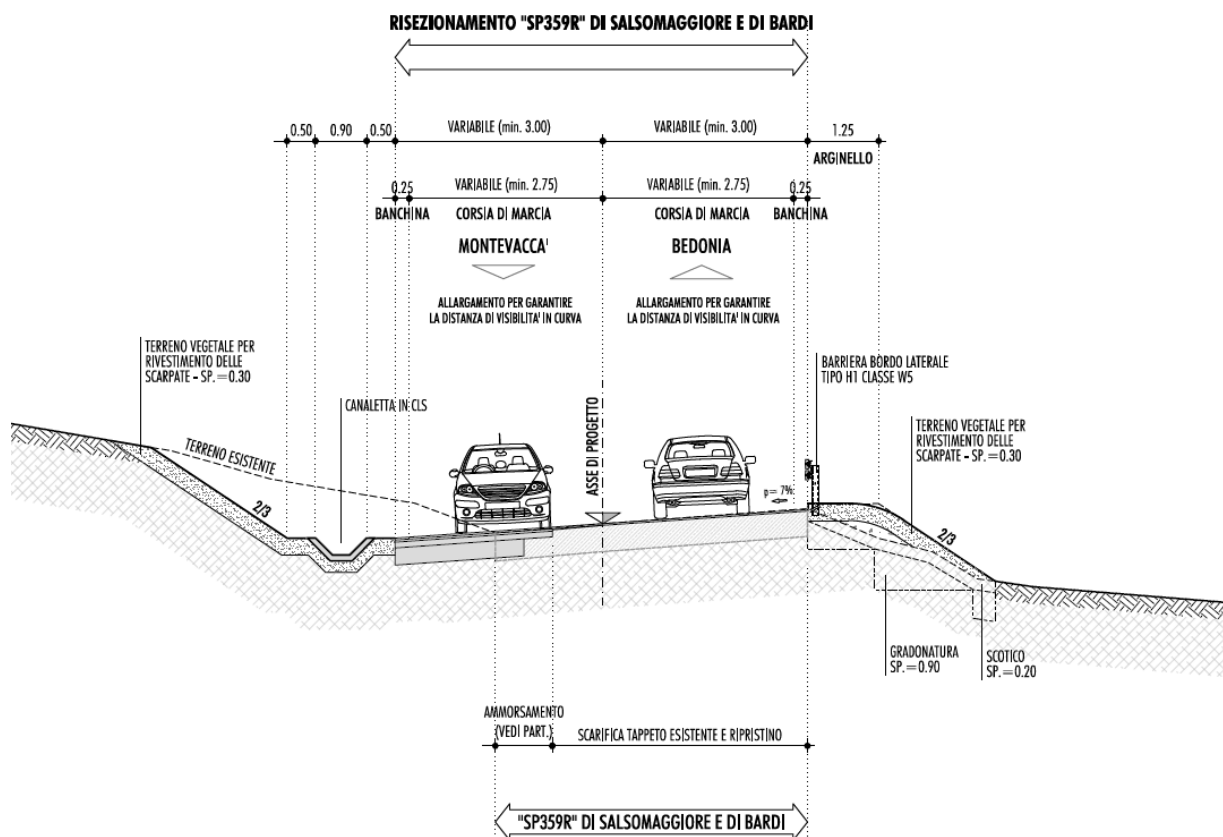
SEZIONE TIPO TRATTO 1 CON AMPLIAMENTO RILEVATO
